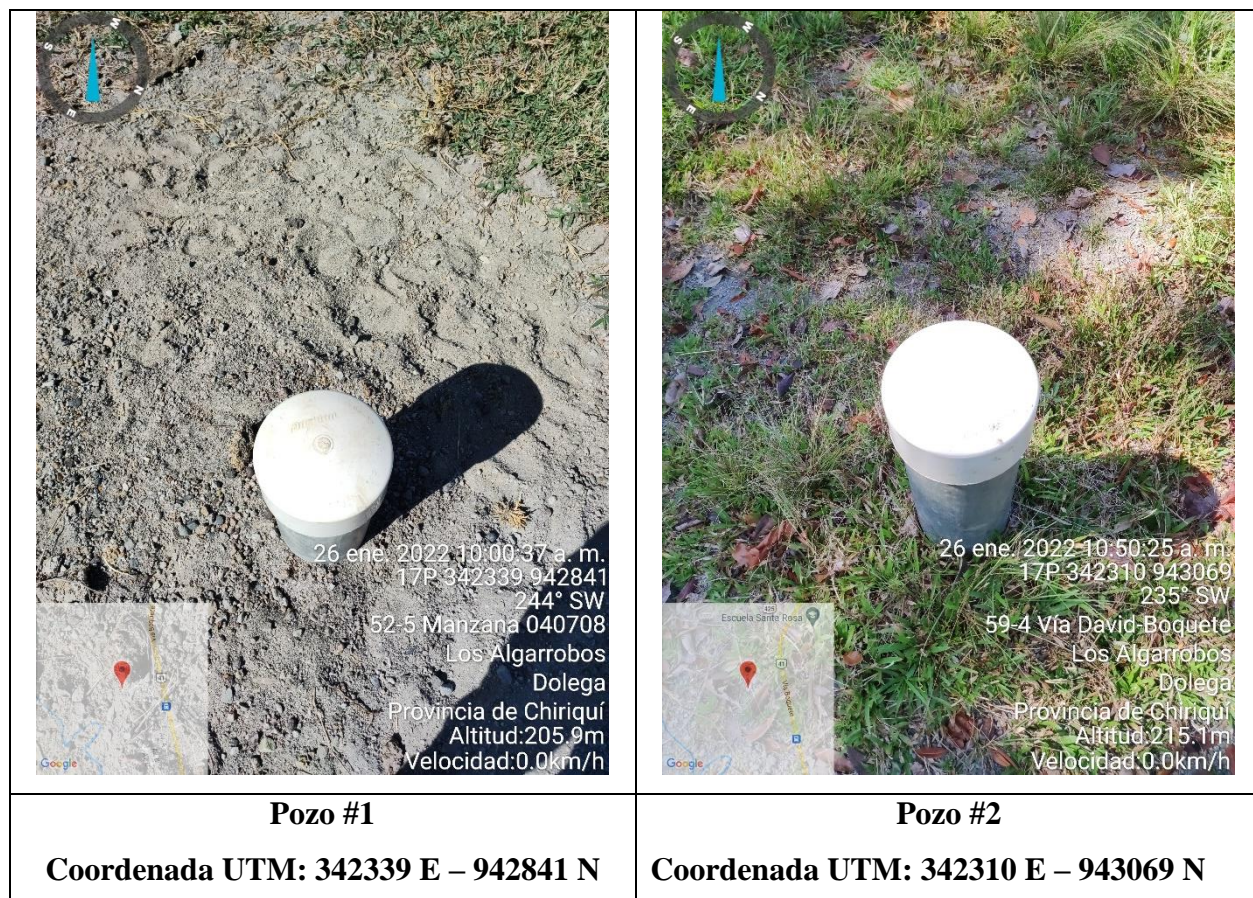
Fotografía de los dos pozos y ubicación UTM dentro del proyecto
